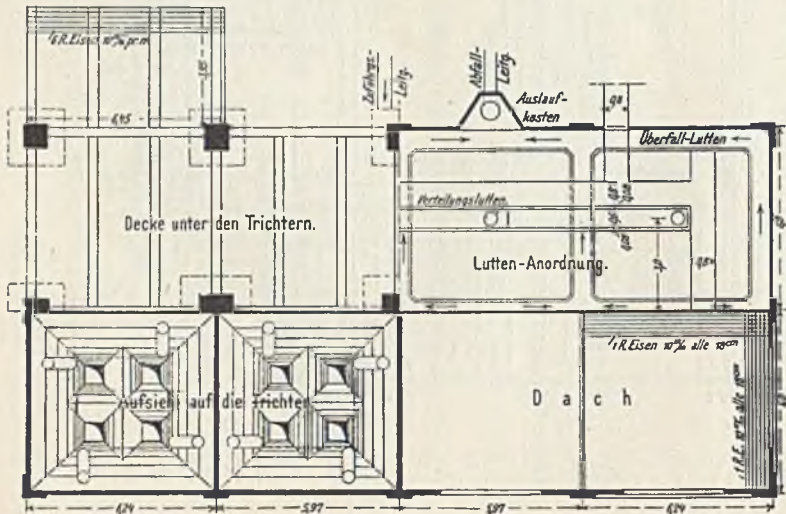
Grundrisse in verschiedener Höhenlage.
